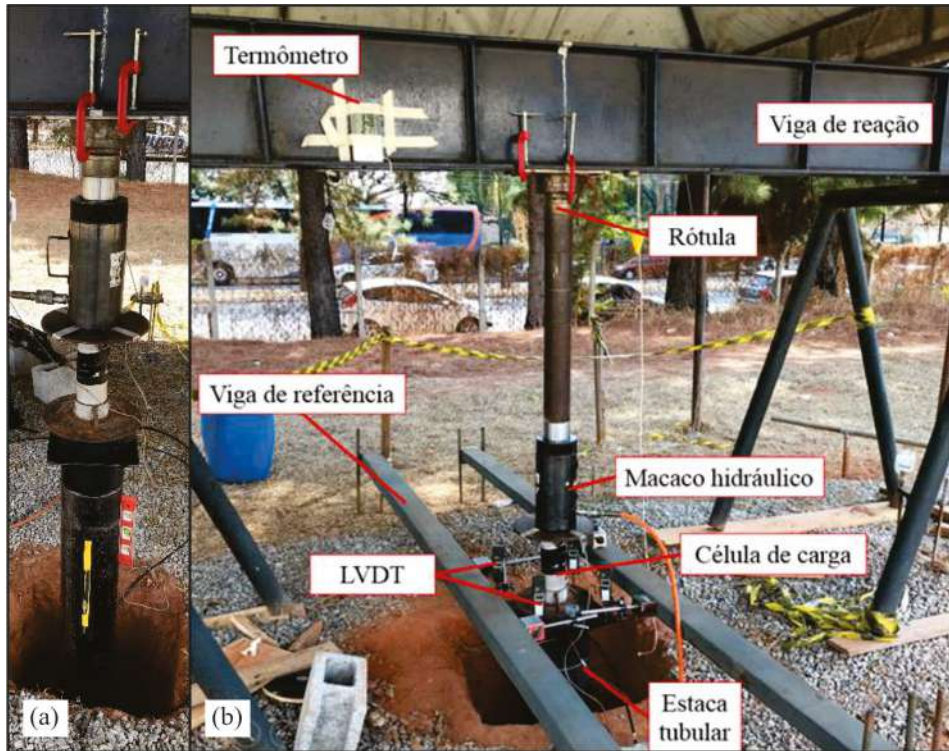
(a) prensagem da estaca metálica, (b) aparato da prova de carga. Adaptado de Galvani Jr (2020).
